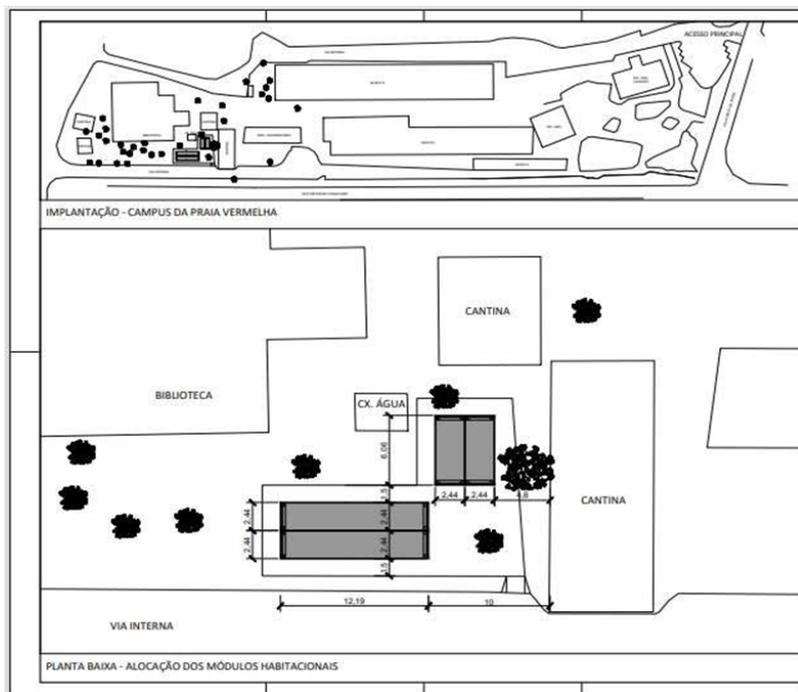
Planta baixa da alocação dos módulos habitacionais no Campus da Praia Vermelha
